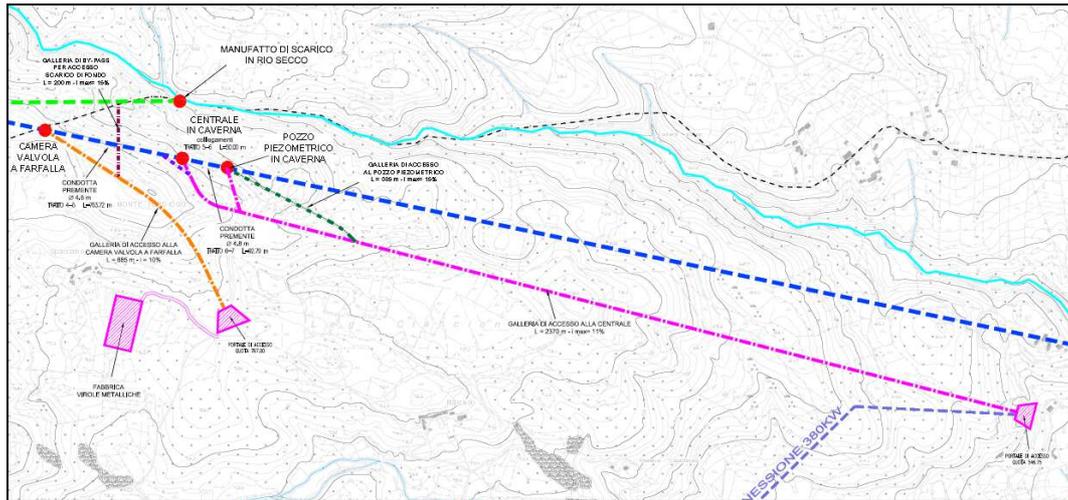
stralcio planimetrico tracciato galleria di collegamento
